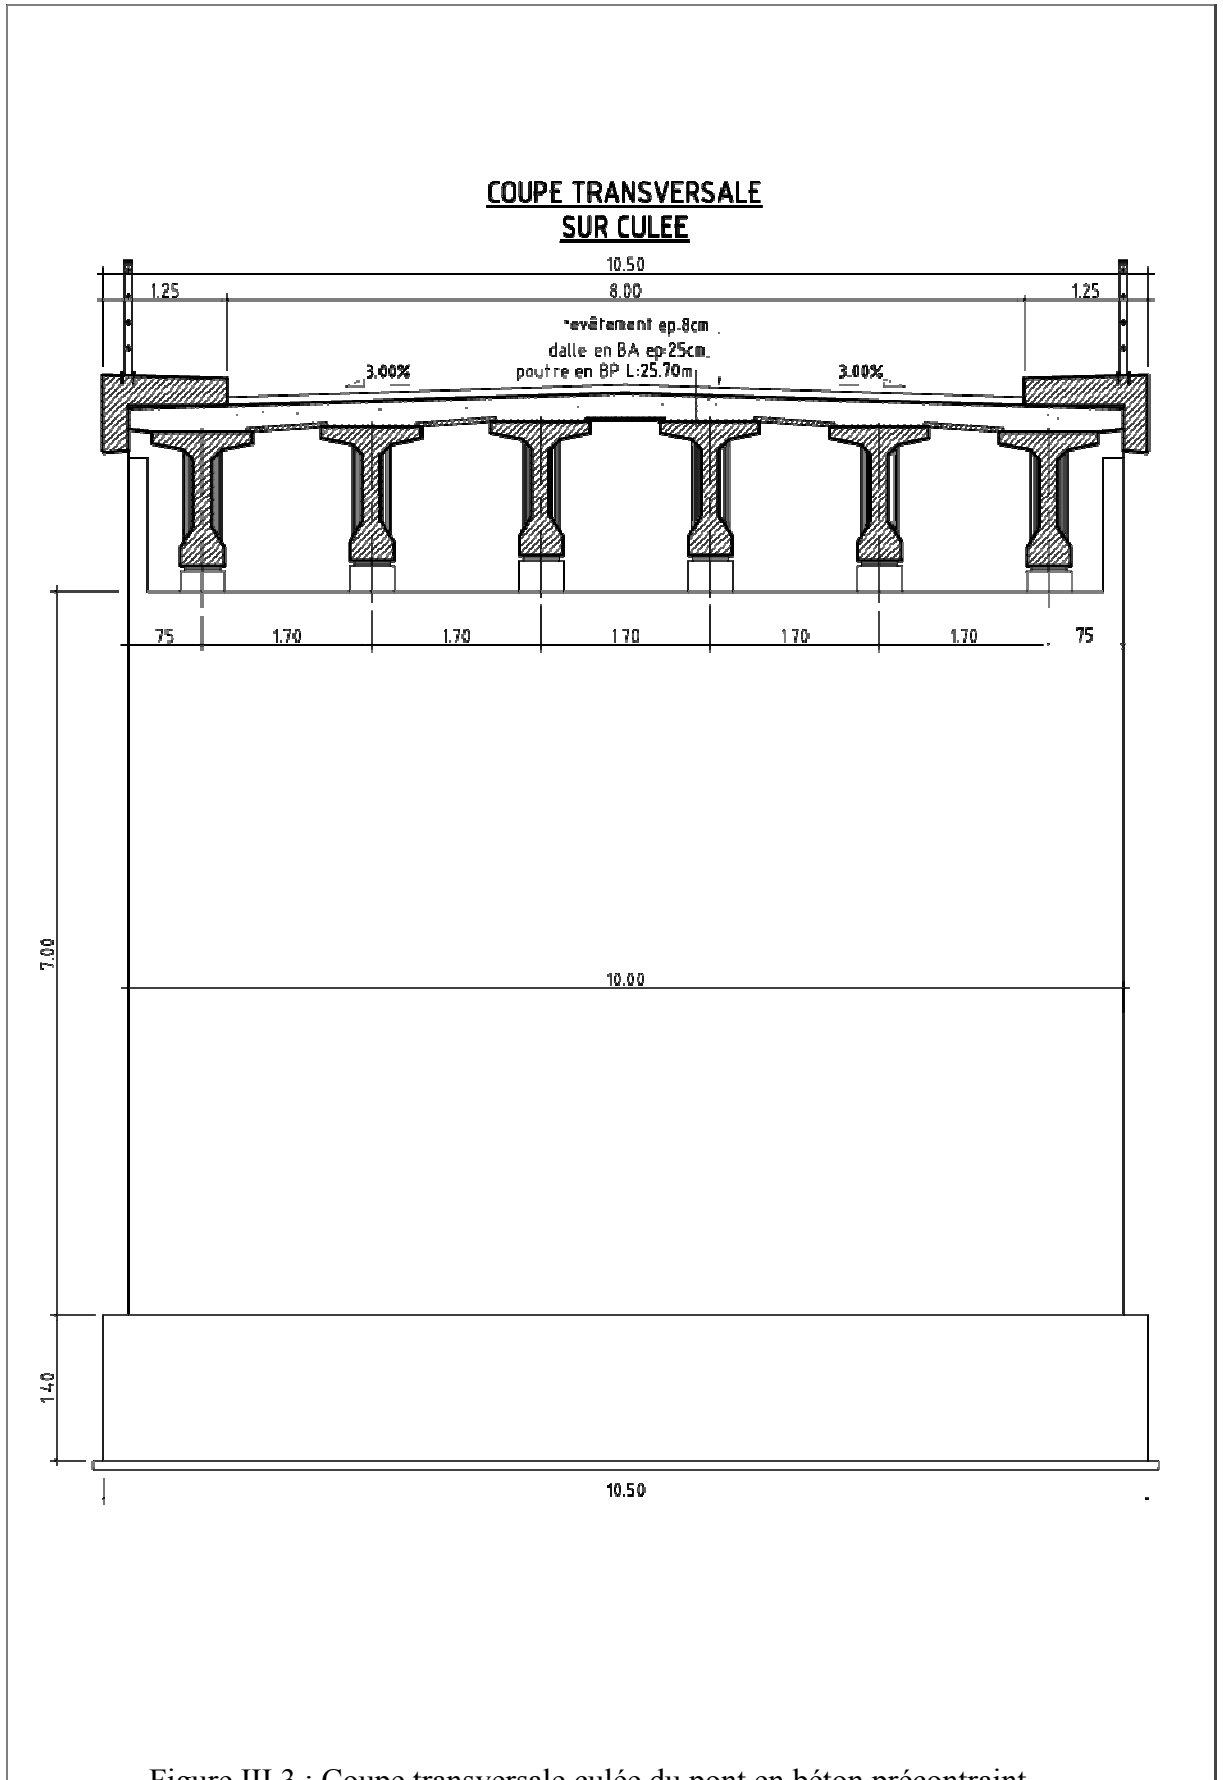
Coupe transversale culée du pont en béton précontraint.
